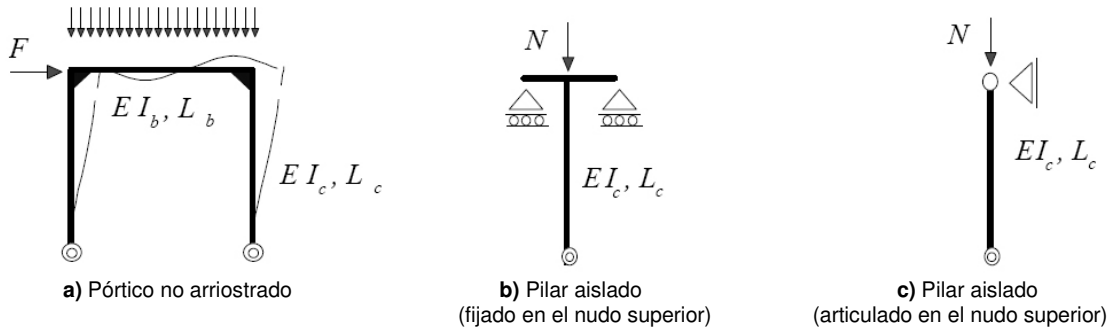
Pórtico no arriostrado y pilares aislados para el estudio de clasificación.
